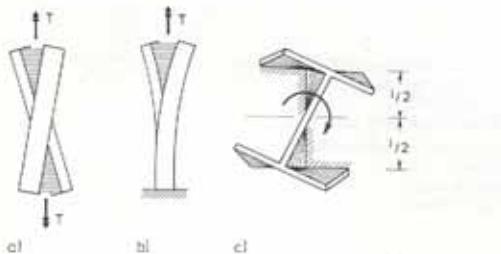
Die zwei Grundformen der Torsionsbeanspruchung
